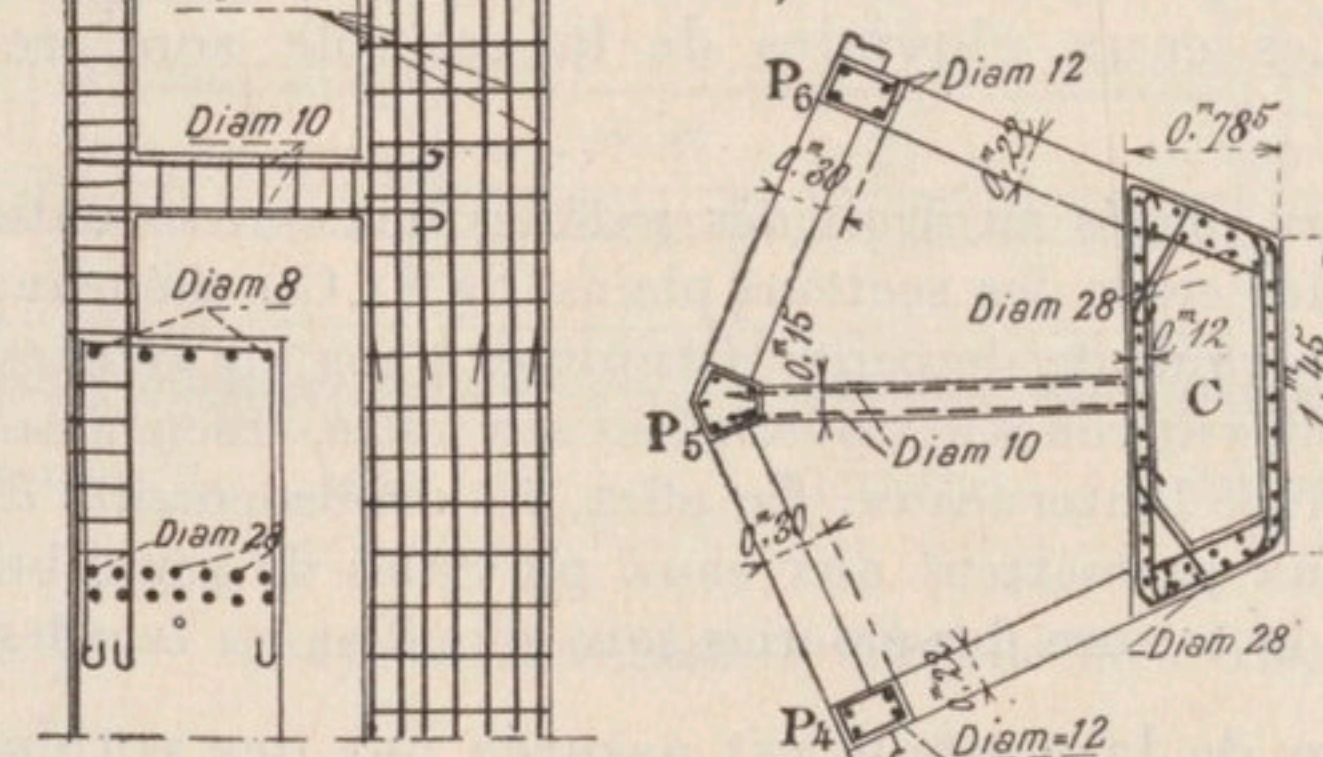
et 10. — Détails du ferrillage d'un des poteaux principaux.
